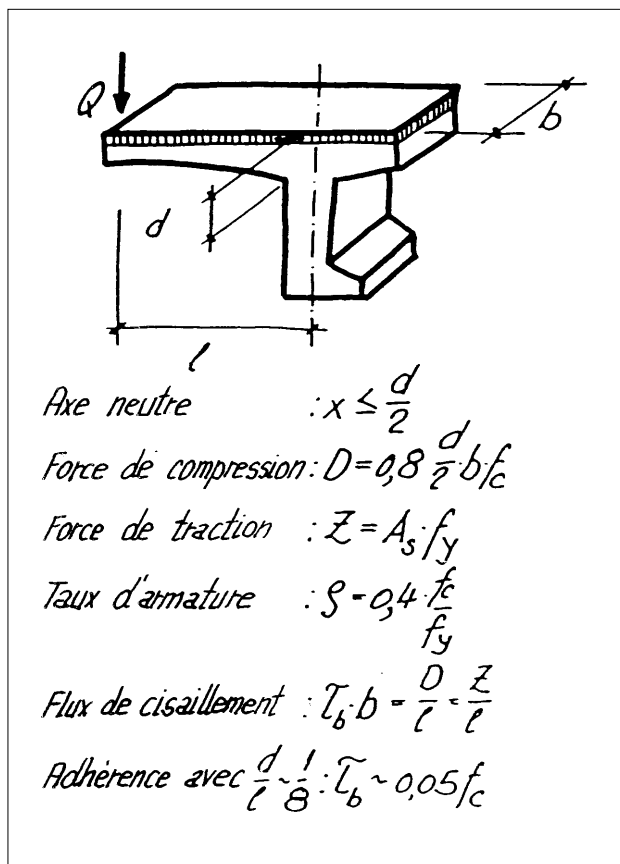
Ordre de grandeur de  $\tau_b$  dans une section de béton.
